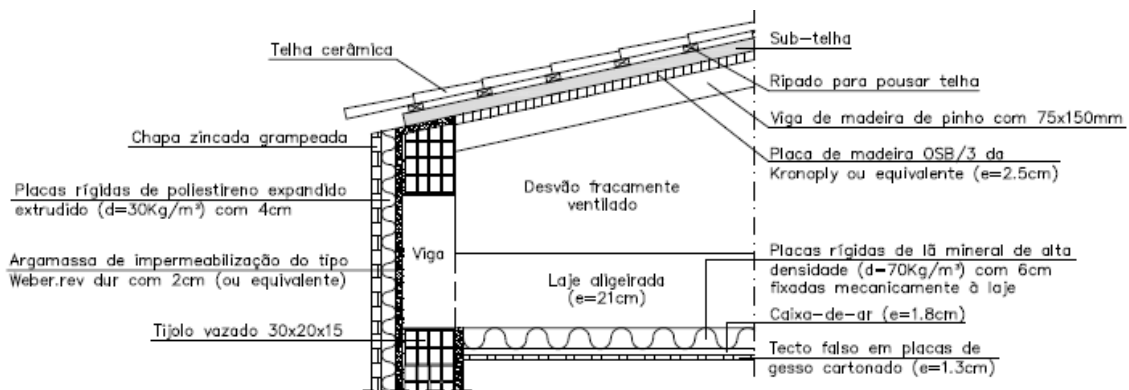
Pormenor de ligação da fachada do piso recuado com laje da cobertura (Projeto de CT)
